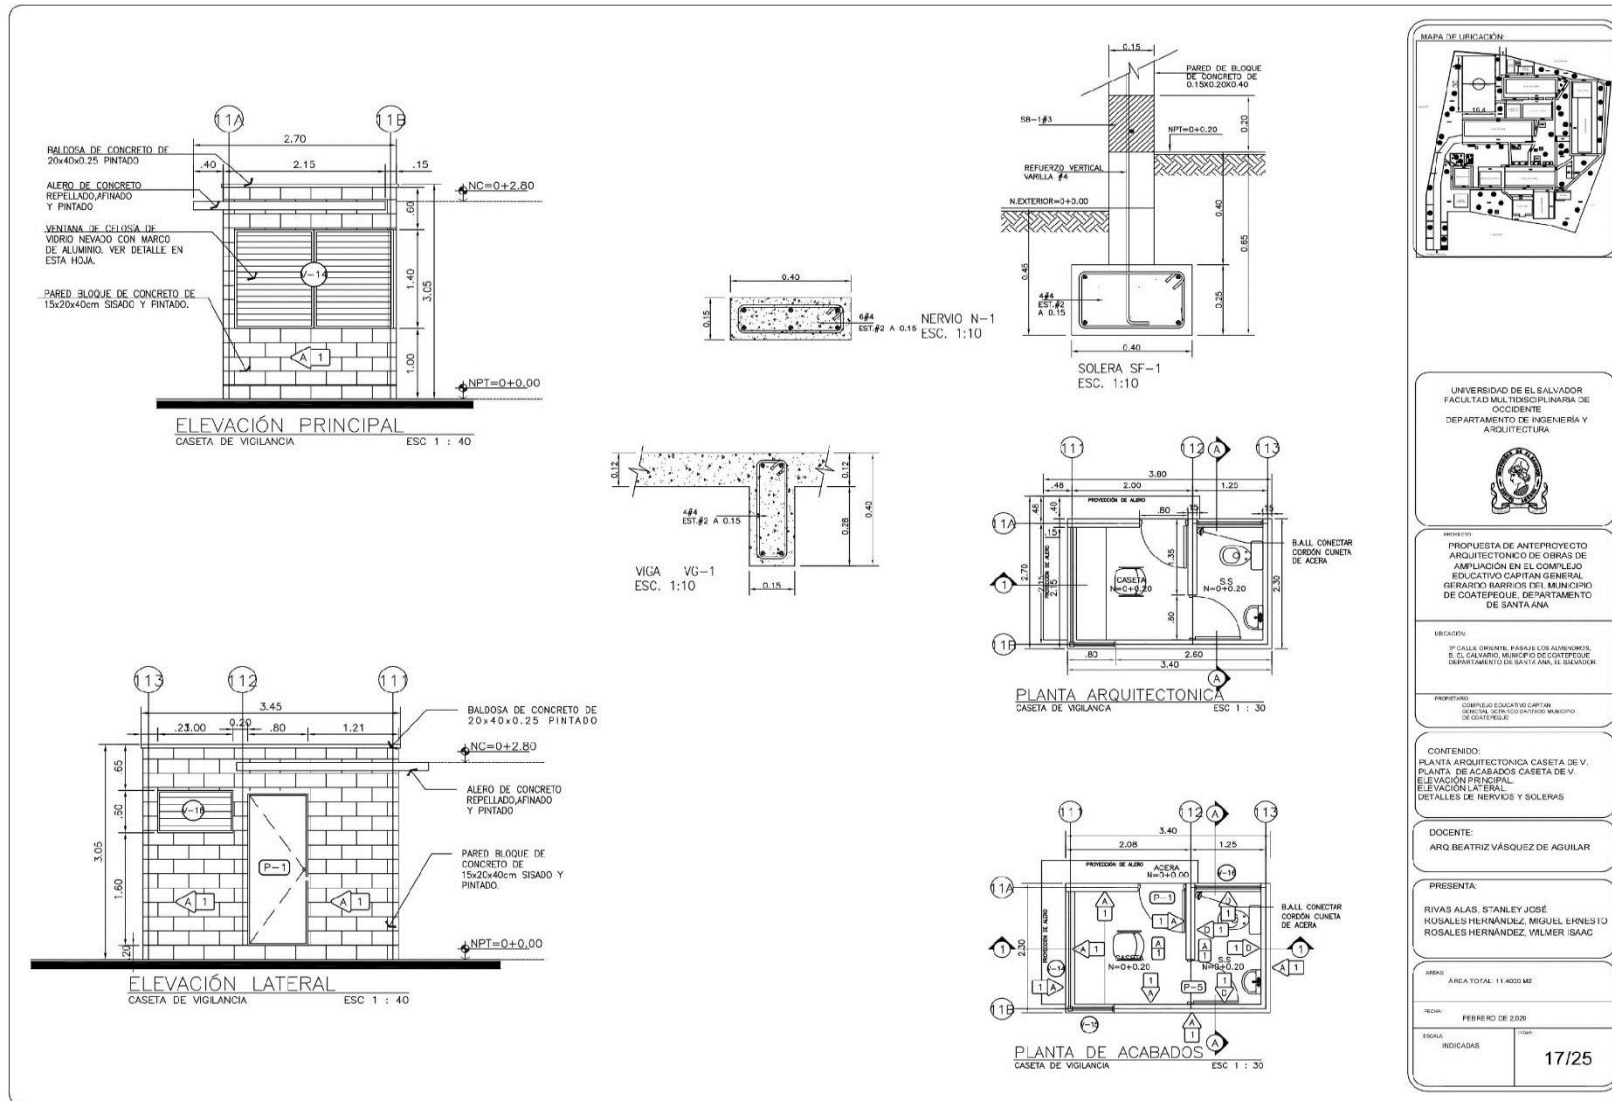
PLANTA ARQUITECTÓNICA, CASETA DE VIGILANCIA "PROPUESTA DE ANTEPROYECTO".
